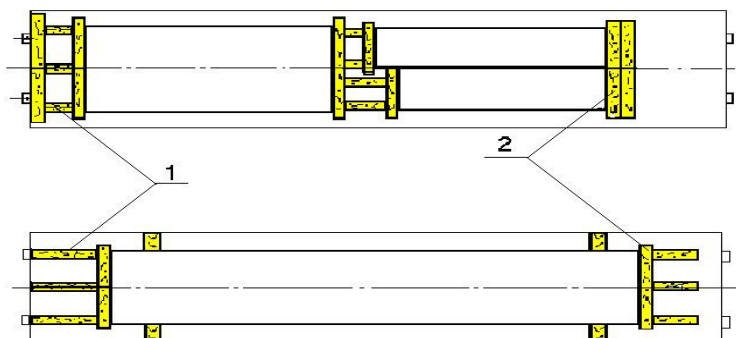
Типовые схемы установки распорных и упорных брусков
